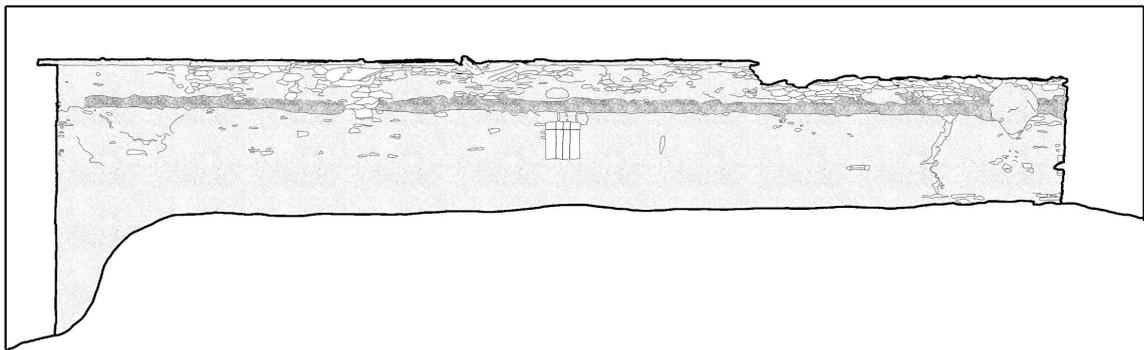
Andriani Mario. prospetto nord-ovest - edificio principale
